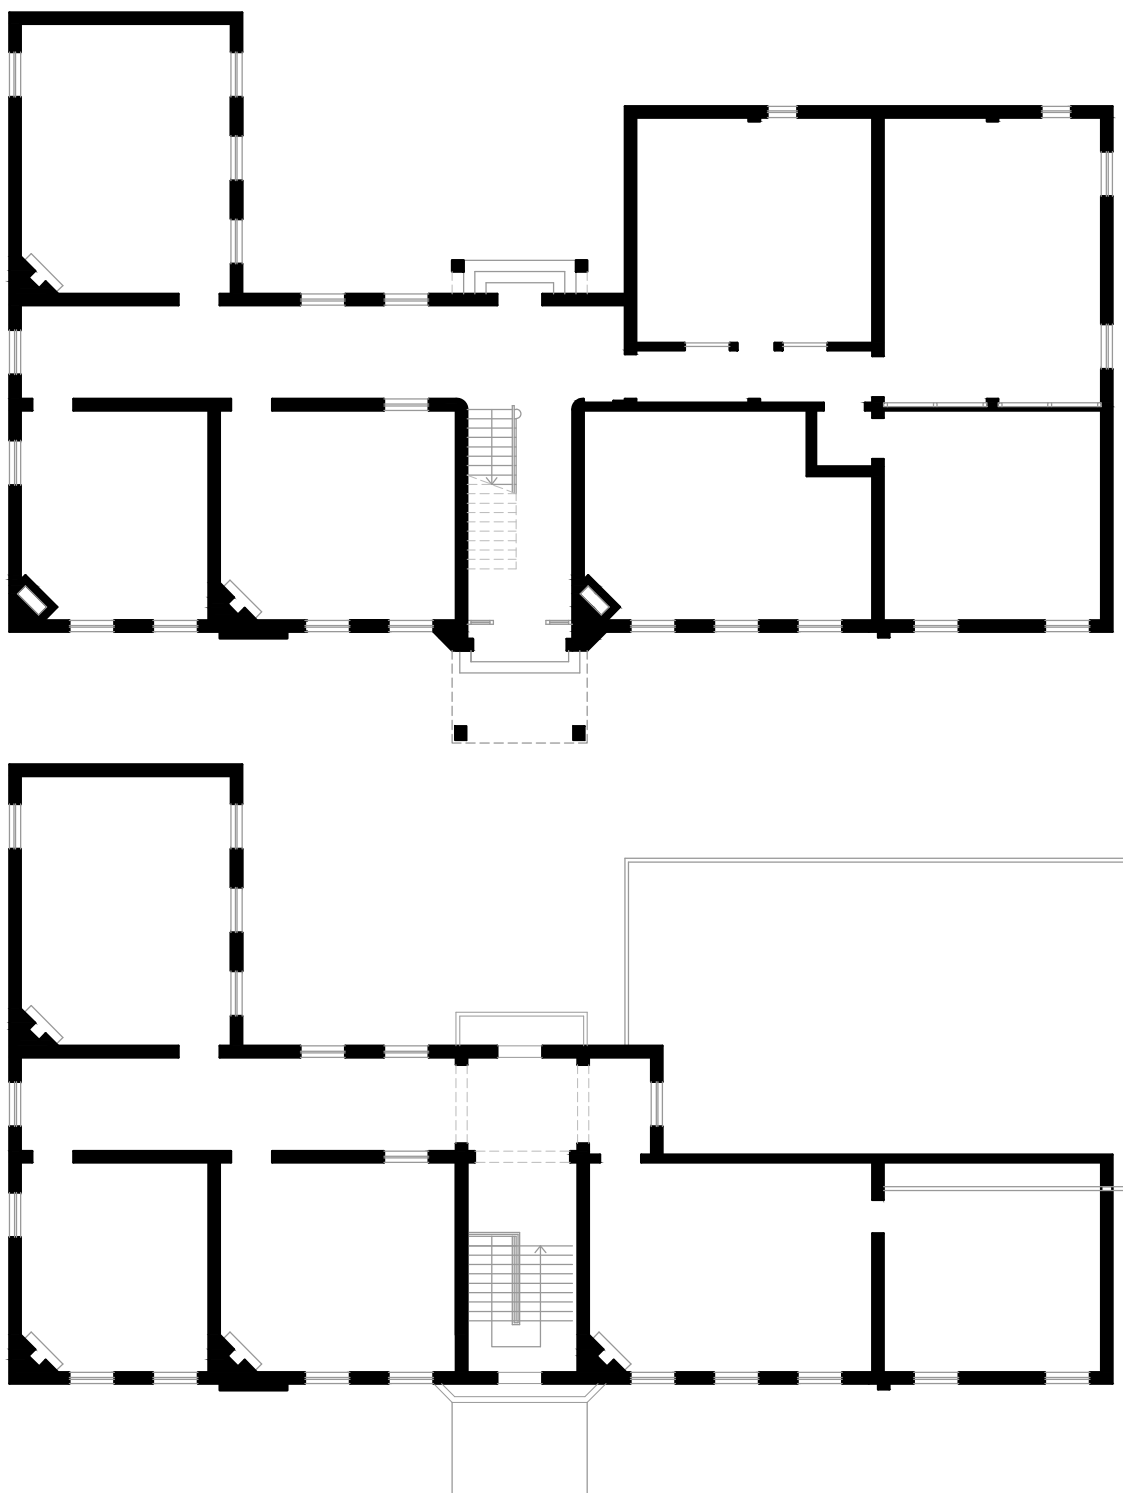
Edificio del Colegio Secundario, planta baja y planta alta
